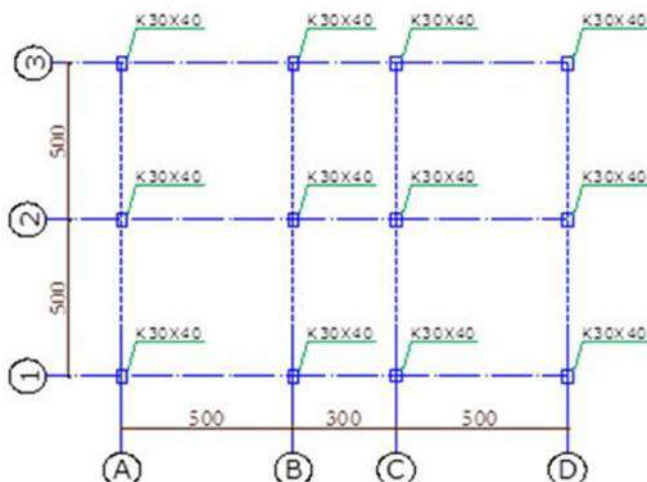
11: Dimensionet në plan të strukturës së objektit
